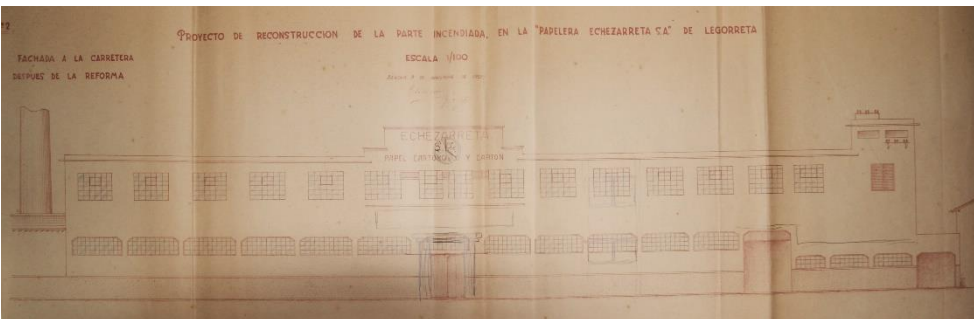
Fachada a la carretera propuesta en el proyecto de reconstrucción. 1951. (AEPE P 1951)
